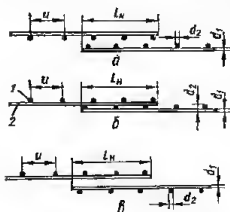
Стыки сварных сеток внахлестку (без сварки) в направлении рабочей арматуры, выполненной из круглых гладких стержней, при расположении поперечных стержней:
